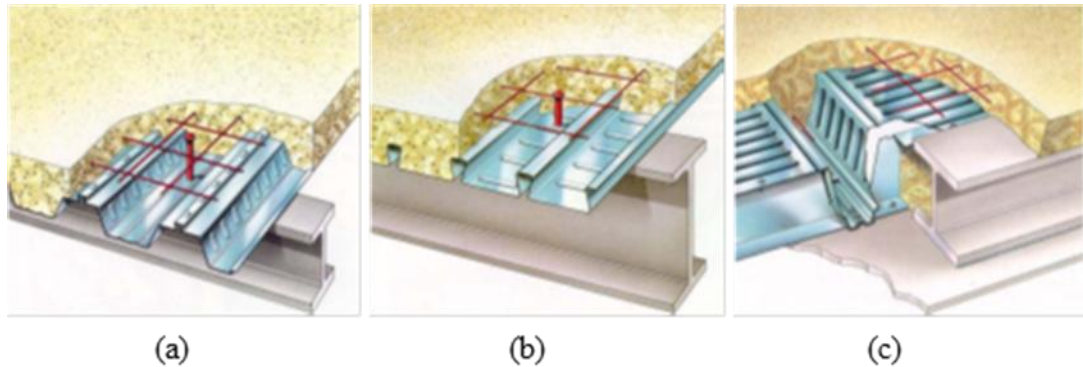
Tipos de perfis de chapas perfiladas: (a) perfil trapezoidal; (b) perfil reentrante e (c) perfil alto (“Lajes mistas,” n.d.).
